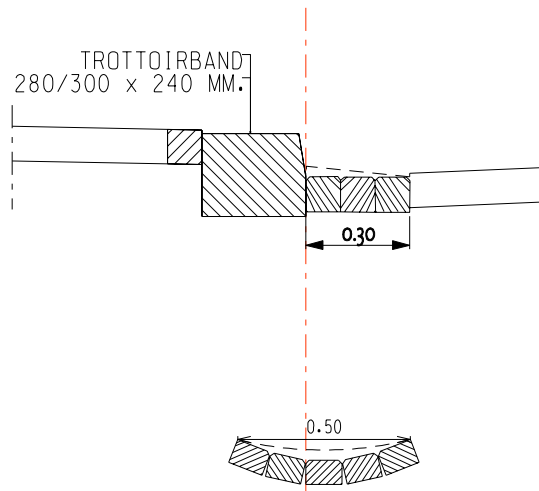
DETAIL GOOTCONSTRUCTIE 7-STREKKEN.
